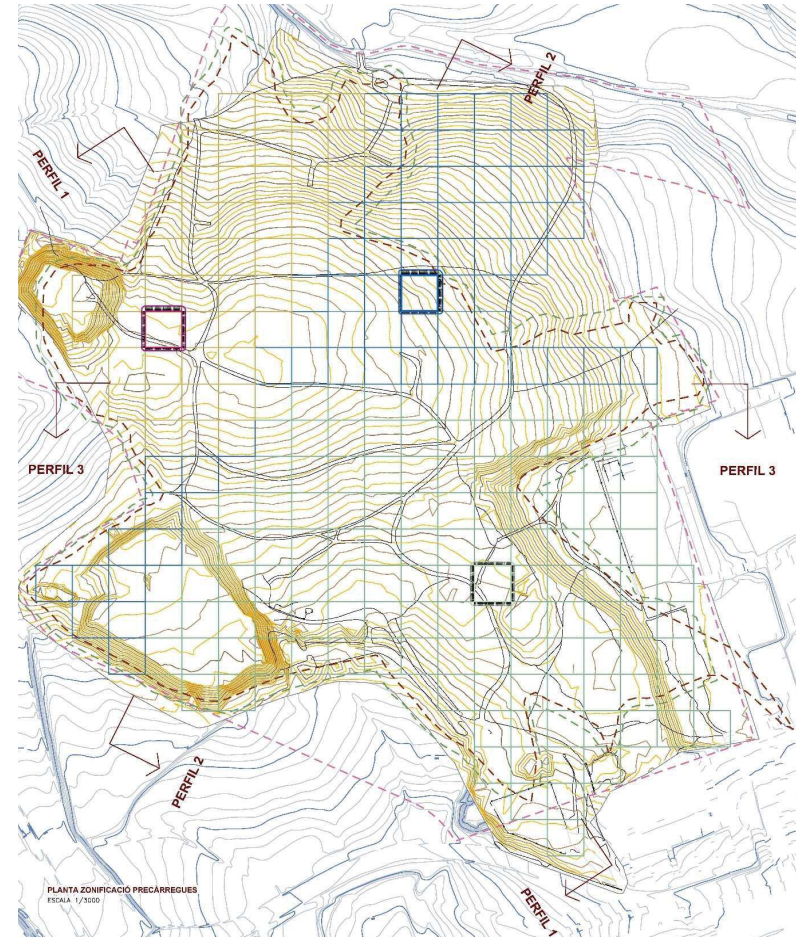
Planta de zonificació de les zones de precàrrega en base als perfils extrets
